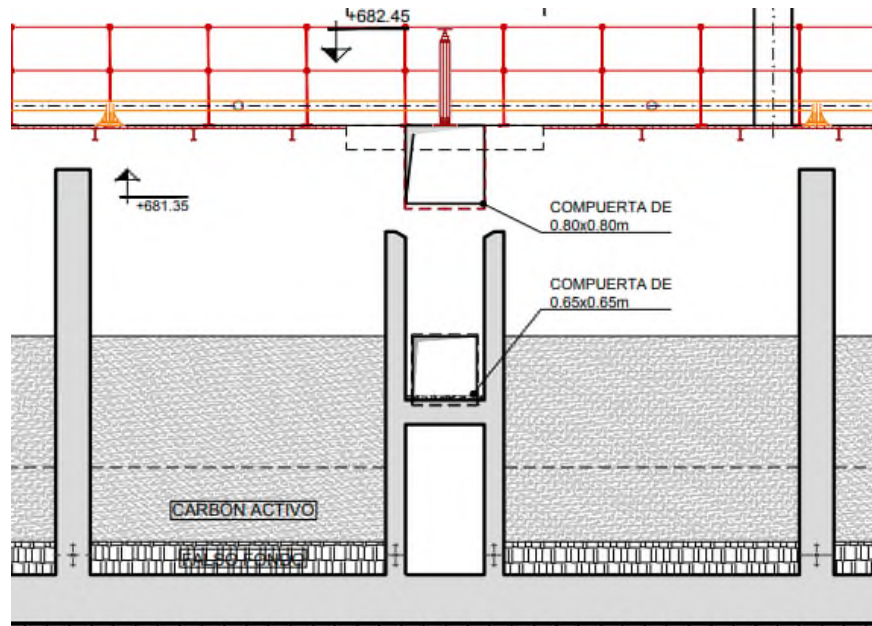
Sección transversal de los filtros de carbón activo con el muro central en H
